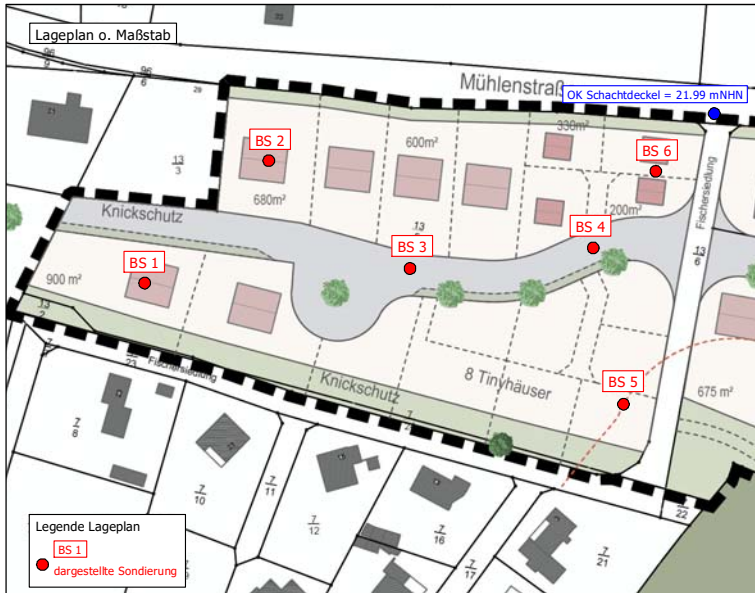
Lageplanausschnitt s. Anl. 1.1_2022, (o. M.)
